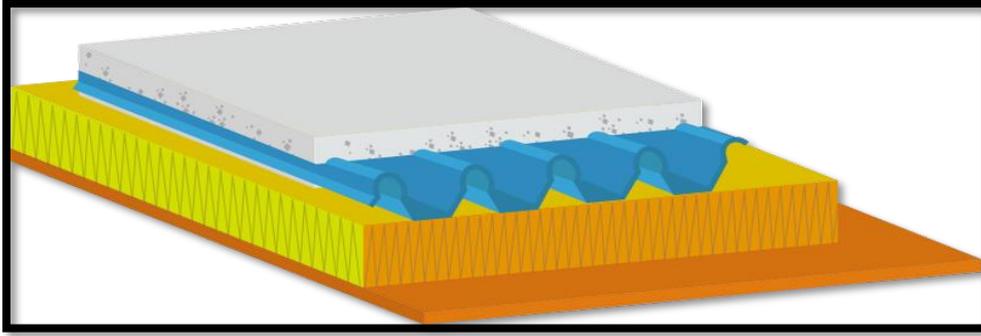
Dalle avec plafond coupe-feu et isolation<sup>204</sup>
